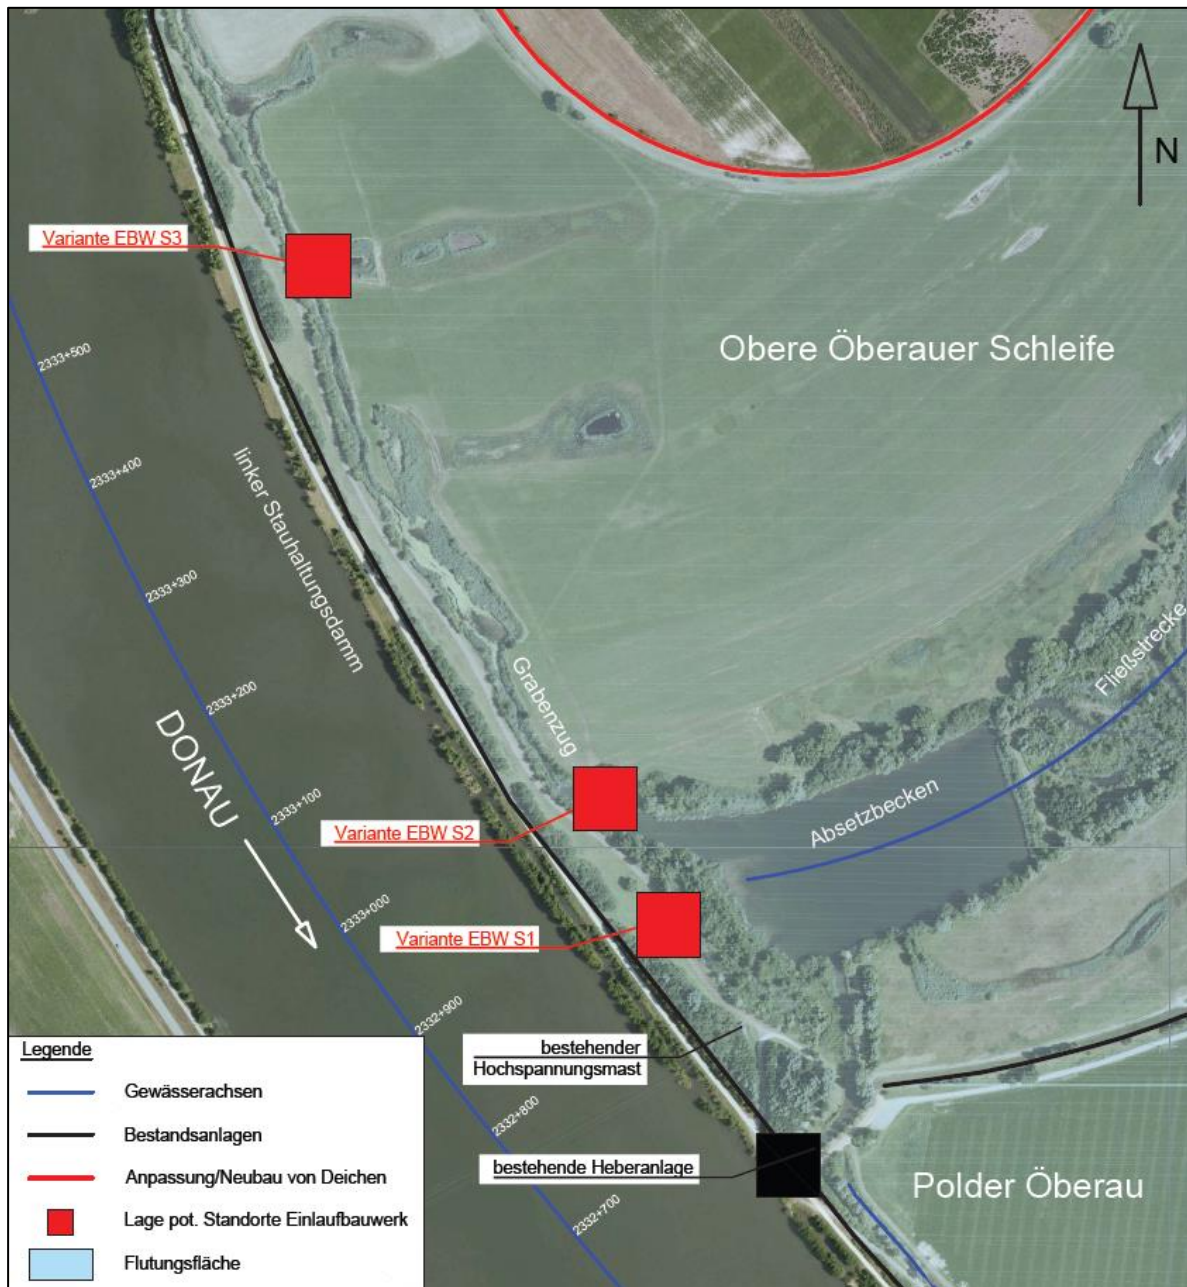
Standortvarianten für das Einlaufbauwerk der geplanten Hochwasserrückhaltung
